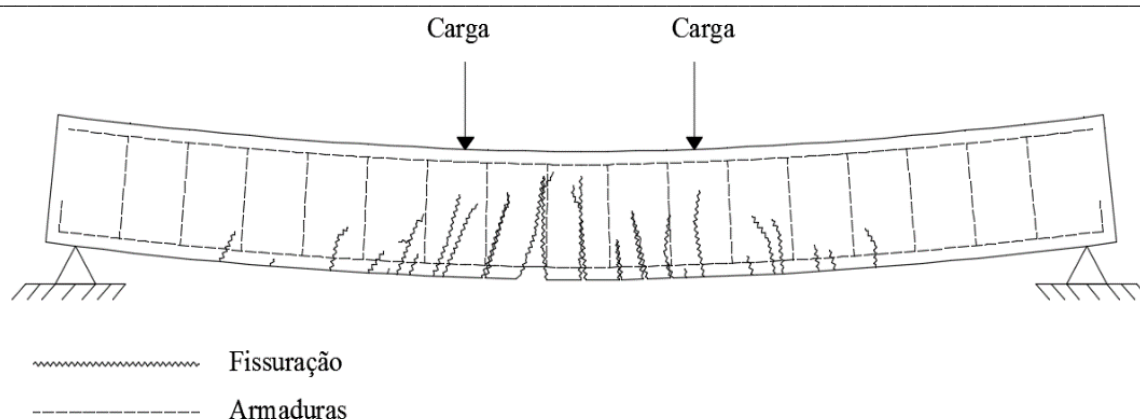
Deformação plástica do aço em viga de betão armado (Silva, 2015)
